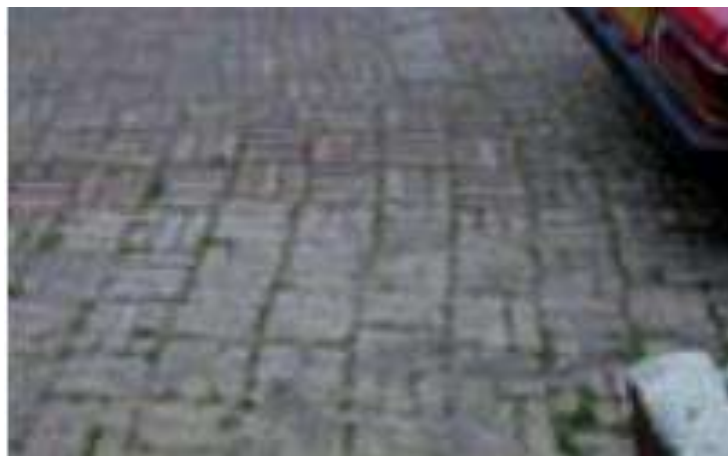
Desplazamiento de borde en pavimentos articulados
